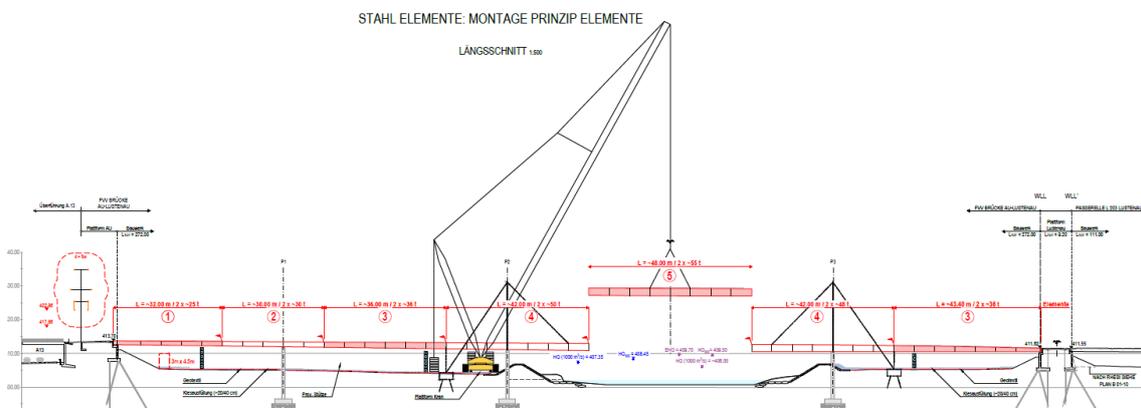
FVV Brücke: Überbau Montage Prinzip [B01-7a Installations und Montageplatz]
